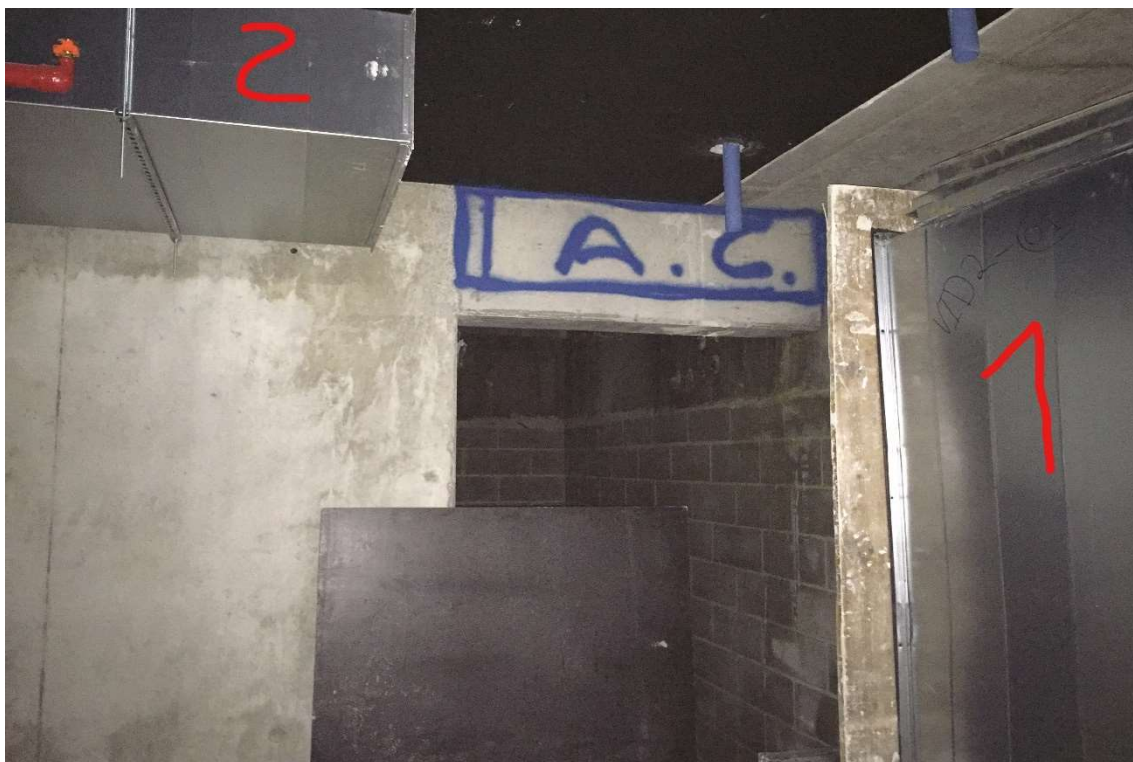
Condutas de AVAC com traçado a colidir com viga de betão armado
